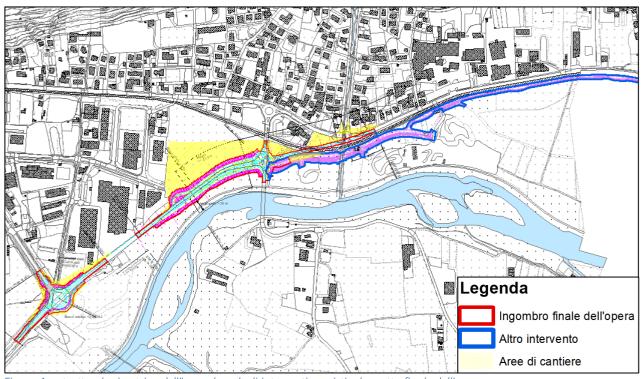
estratto planimetrico dell'ingombro degli interventi previsti ed assetto finale dell'area.
